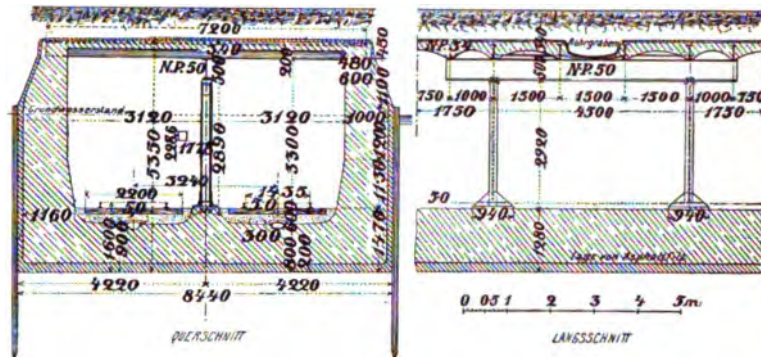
Quer- und Längenschnitt der westlichen Strecke der Berliner Untergrundbahn.
